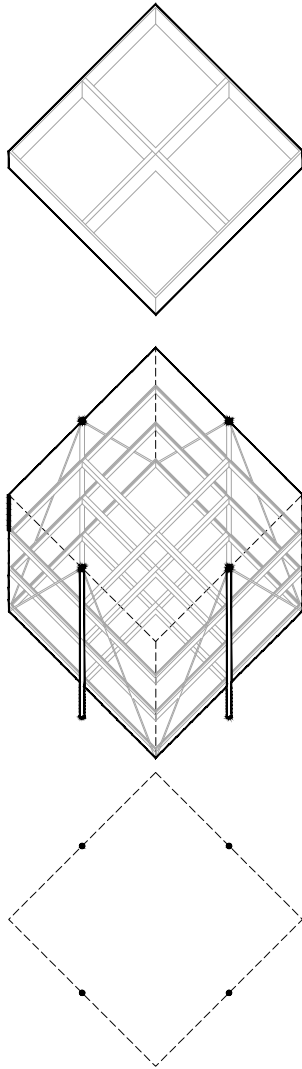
Esquema, estructuras perimetrales. Fuente: Elaboración propia.
